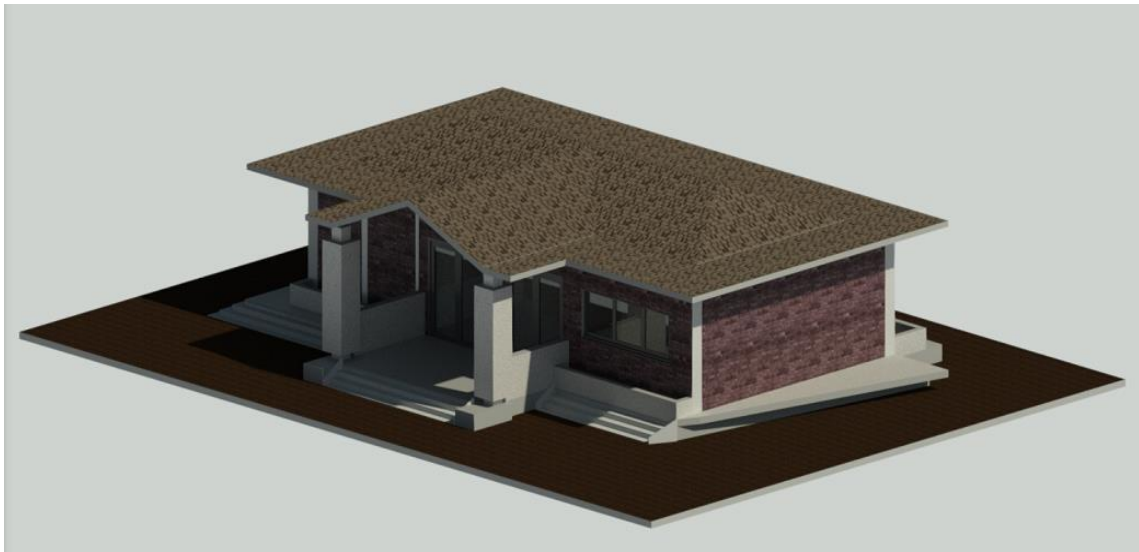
Vista frontal con detallado del levantamiento realizado a través de Autodesk Revit.
